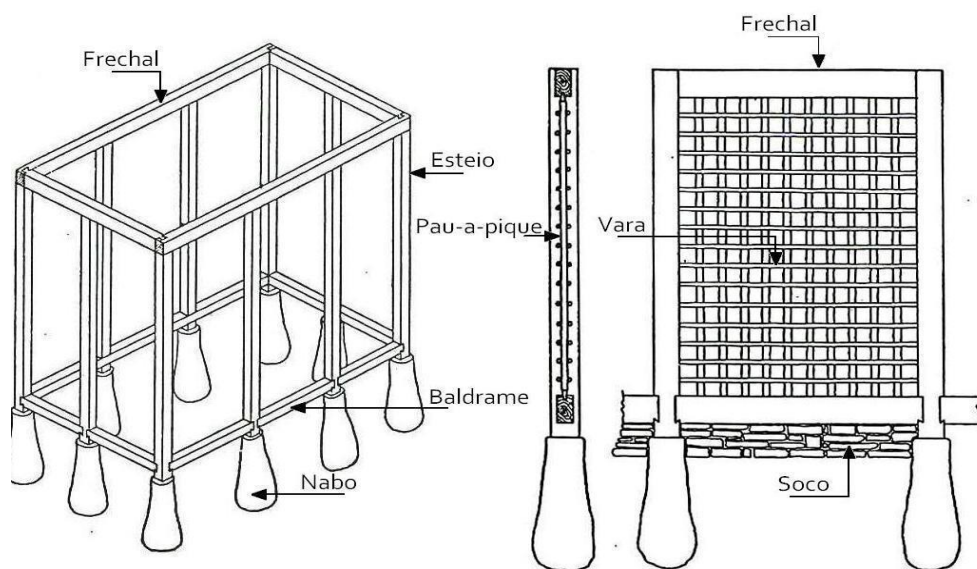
Estrutura de pau-a-pique, a esquerda fundação e componentes estruturais, a direita painel de pau-a-pique, fonte SANTOS P. F. 1951
